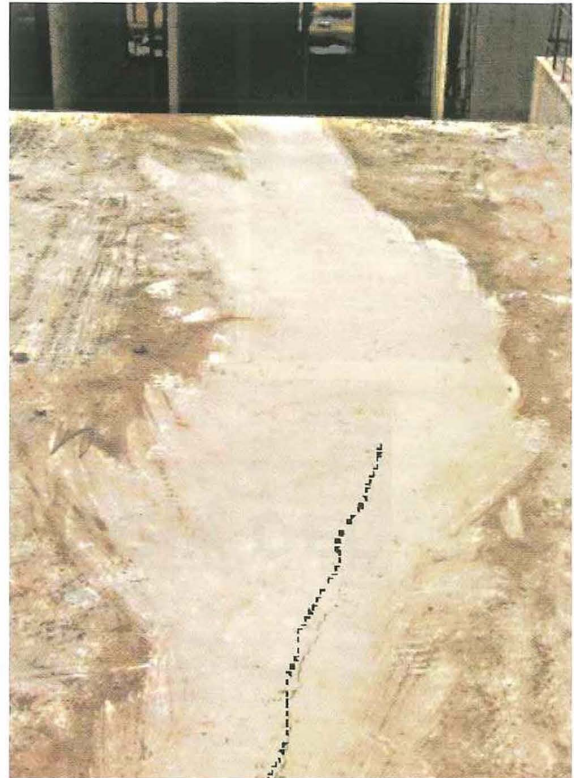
Fisuras en las zonas luces centrales (sala)
